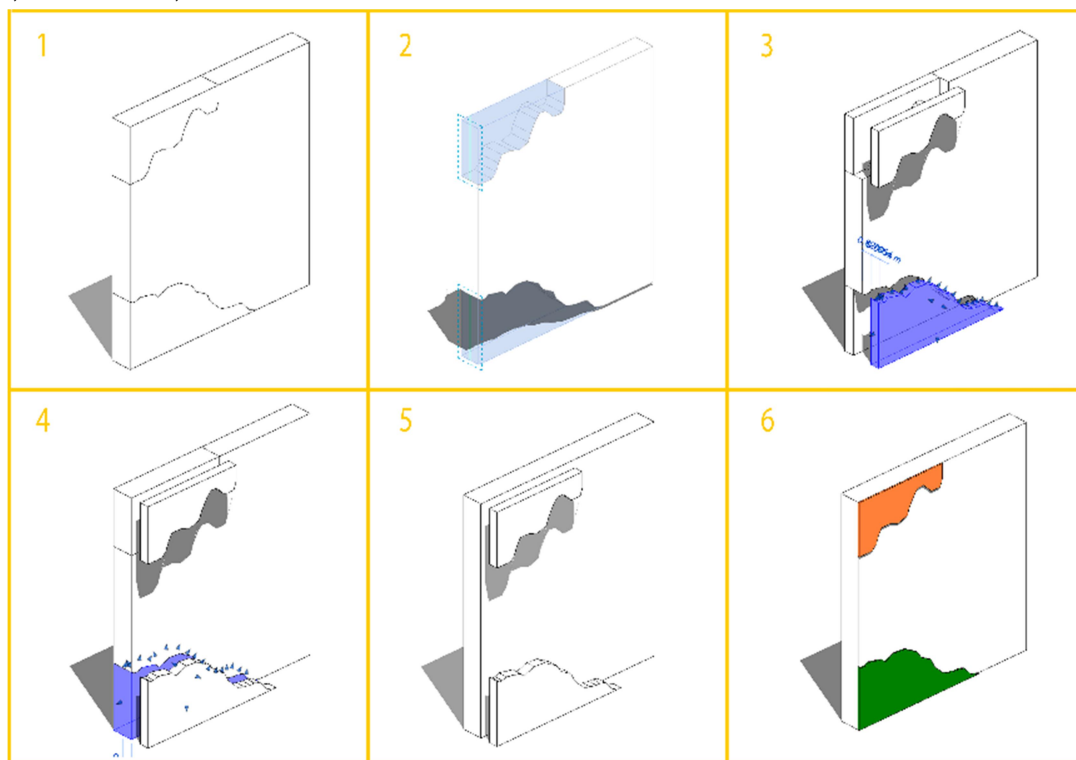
Piezas solapadas. Elaboración propia. Año 2021.
